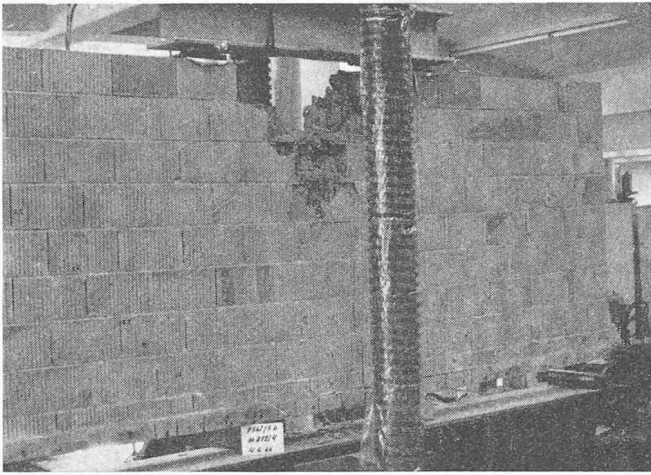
Mit Stahlton-Brett verstärkte Preton-Modellwand bei Bruchversuch (Photo: Prüf- und Forschungsstelle Luzern)
